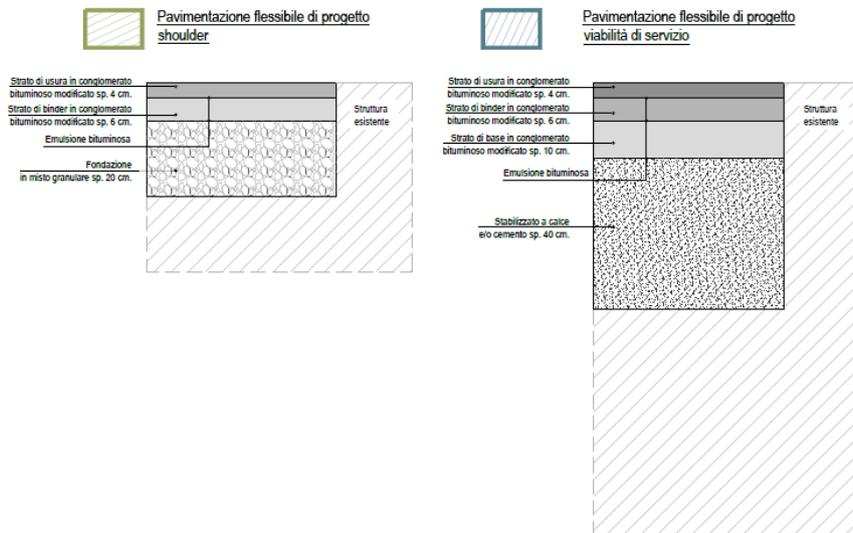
Schemi adottati per la pavimentazione della viabilità e per le shoulder.
